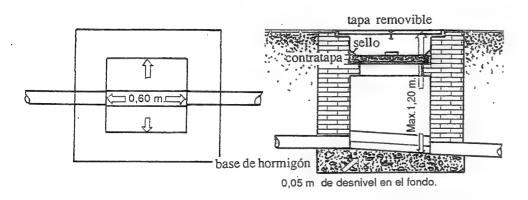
VII Cámara de inspección de hormigón, 0,60x 0,60m.
